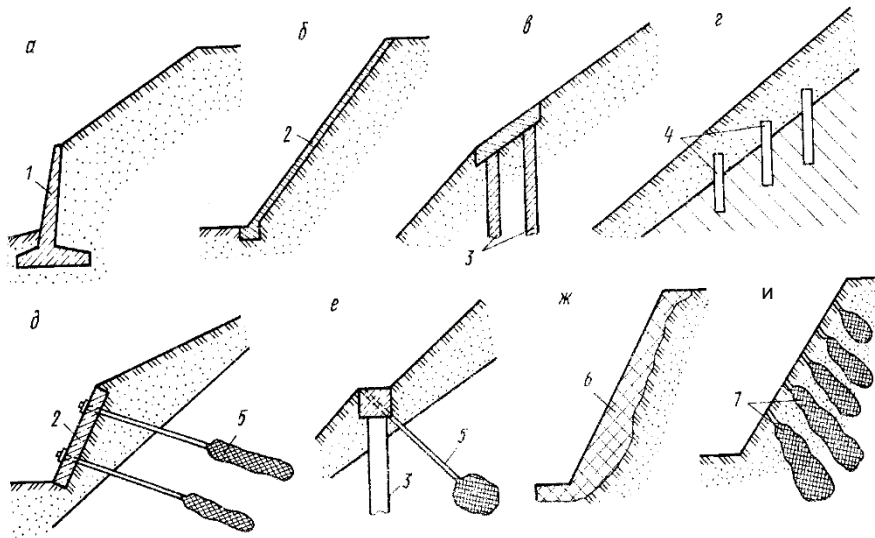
Зміцнення укосів виїмок: а – тонкими підпірними стінками; б – захисними покриттями з плит; в – утримувальними пальовими конструкціями; г – пальовими шпонками; д – анкерними пристроями; е – палеанкерною конструкцією; ж – поверхневим закріпленням; и – глибинним закріпленням; 1 – підпірна стінка; 2 – плита; 3 – палі; 4 – шпонка; 5 – анкер; 6 – поверхнєве закріплення; 7 – глибинне закріплення
